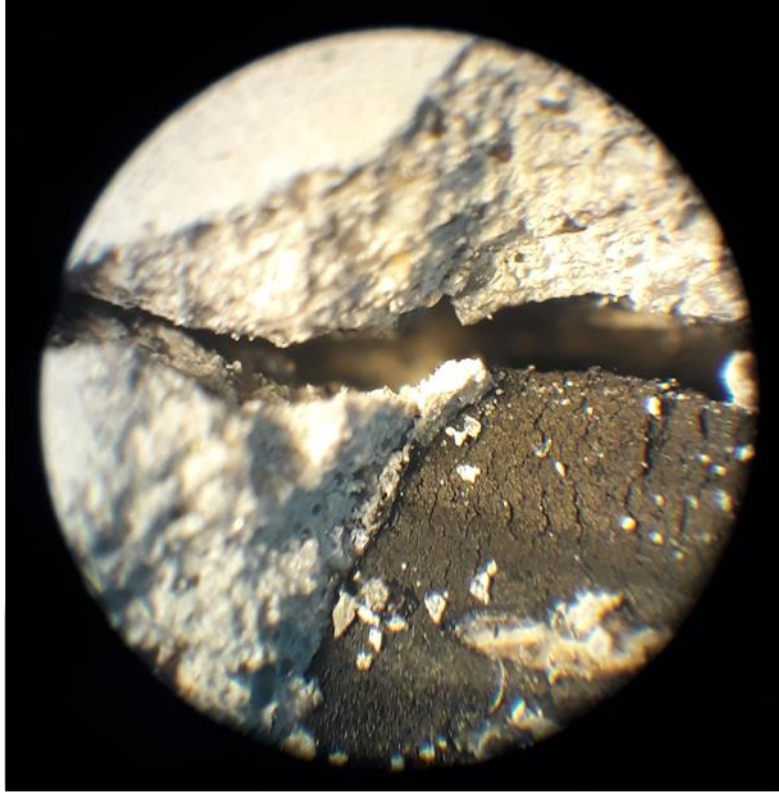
Zona de fisura impactando en pieza de caucho.
